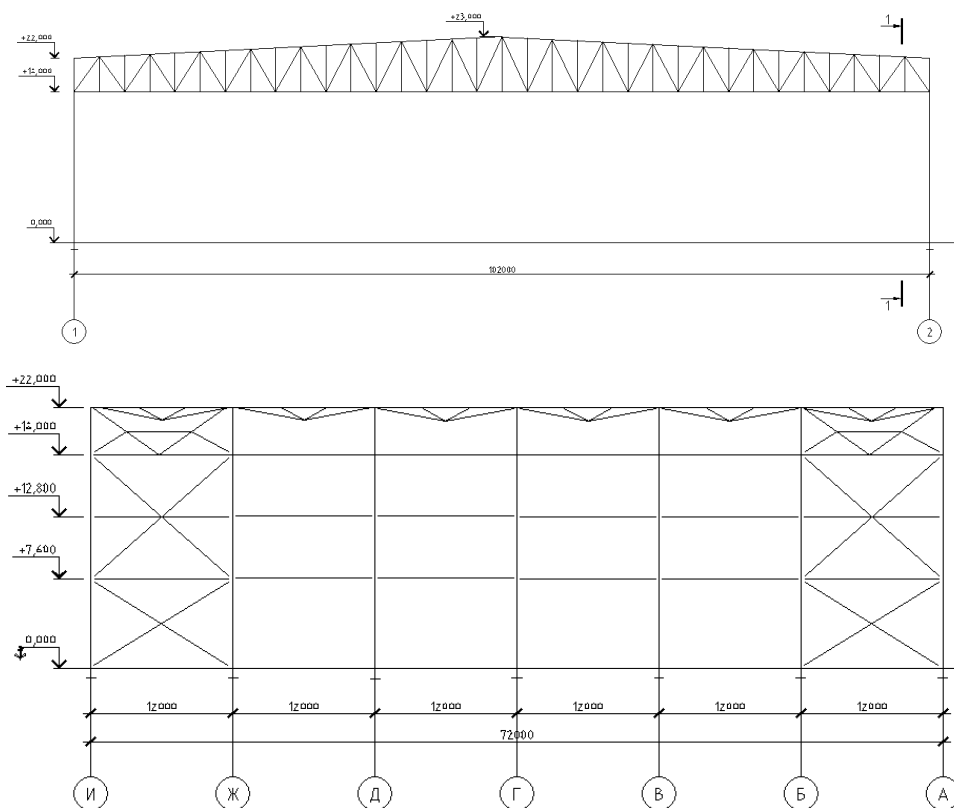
Варіант з балочним покриттям із двоскатних ферм
